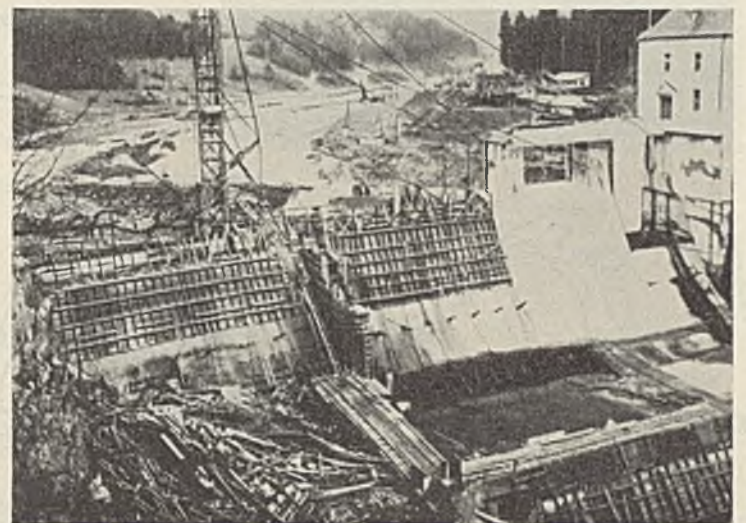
Regensperre. Betoneinbringung im Bauabschnitt III mit Gießturm.
